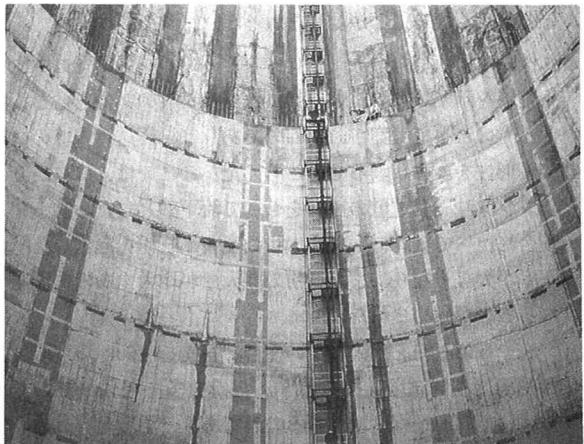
逆打ち高流动コンクリート施工後の壁面状況
